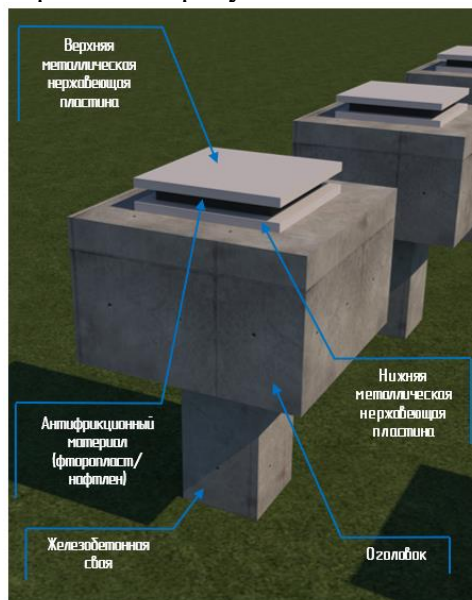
Модель свайного фундамента с элементом сейсмоизоляции
